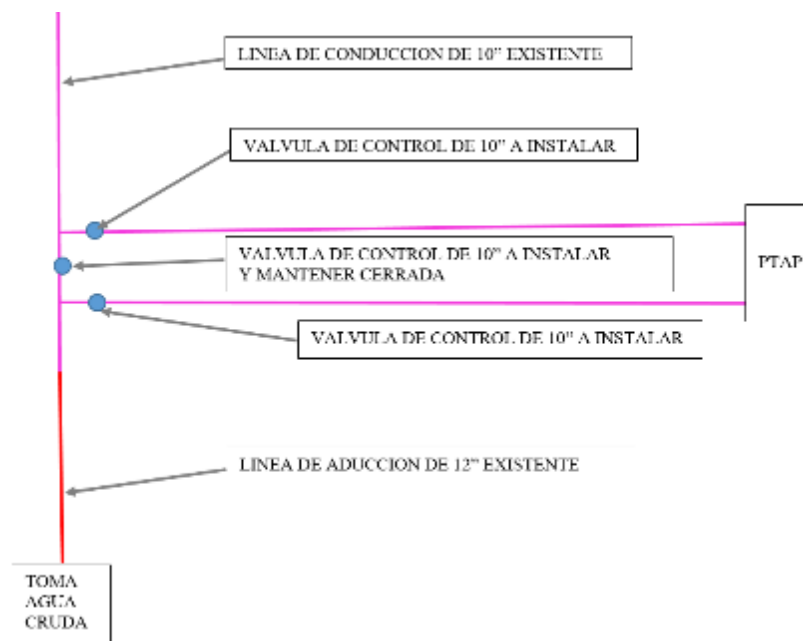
Ruta de la Tubería de Aducción/Conducción a instalar
